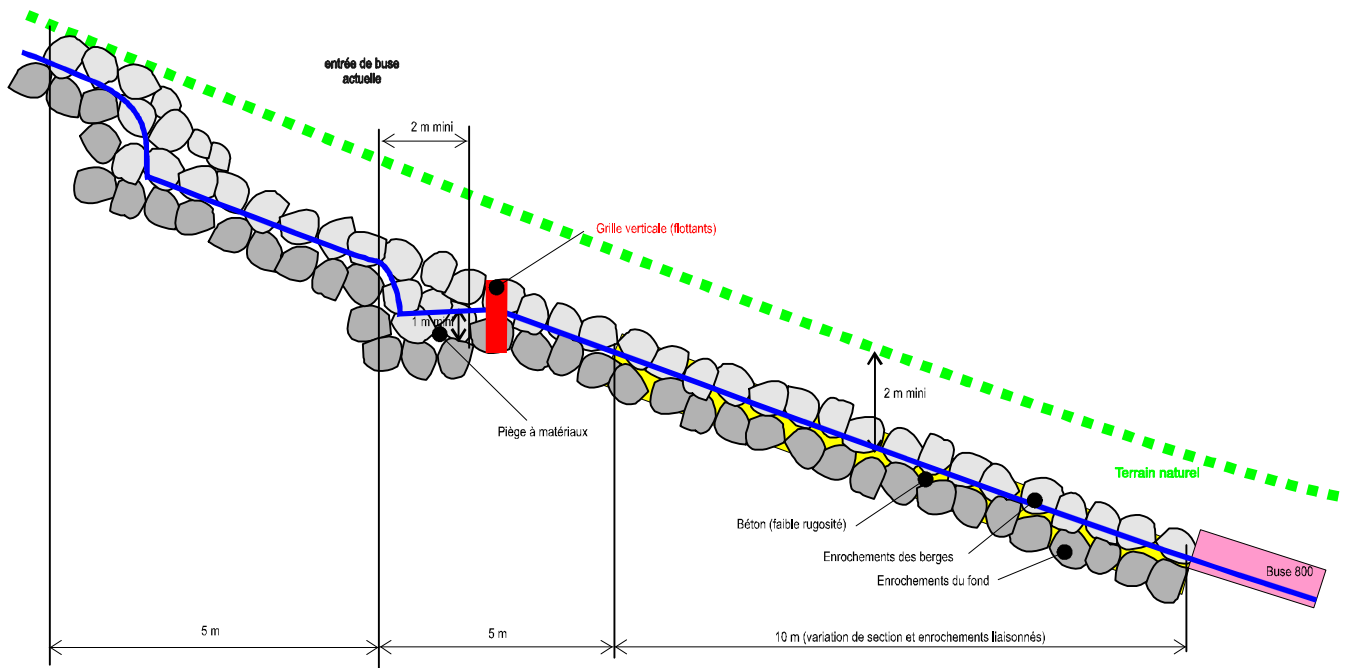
Coupe longitudinale de l'ouvrage amont.
